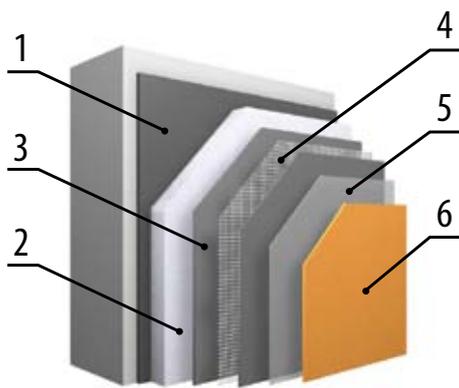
1 – клеящий слой; 2 – аэрогельная теплоизоляция; 3 – паропроницаемое соединение; 4 – армирующий слой; 5 – грунтовка; 6 – покрытие
